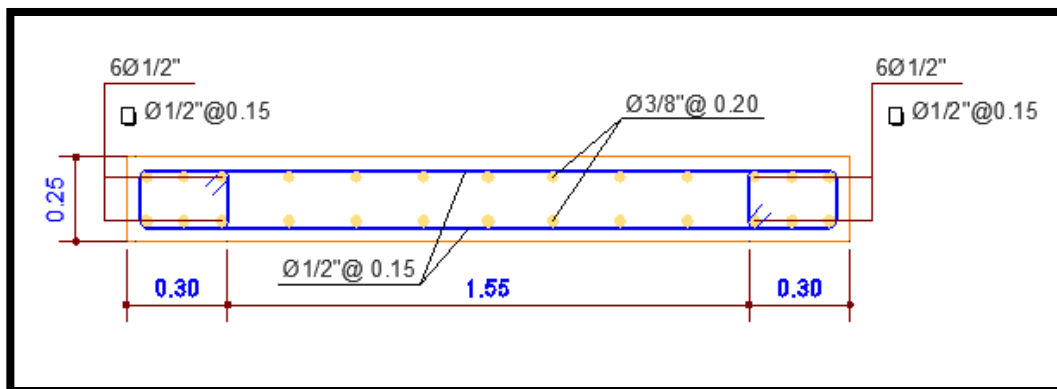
DISTRIBUCIÓN DE ACERO PLACA PL-5
